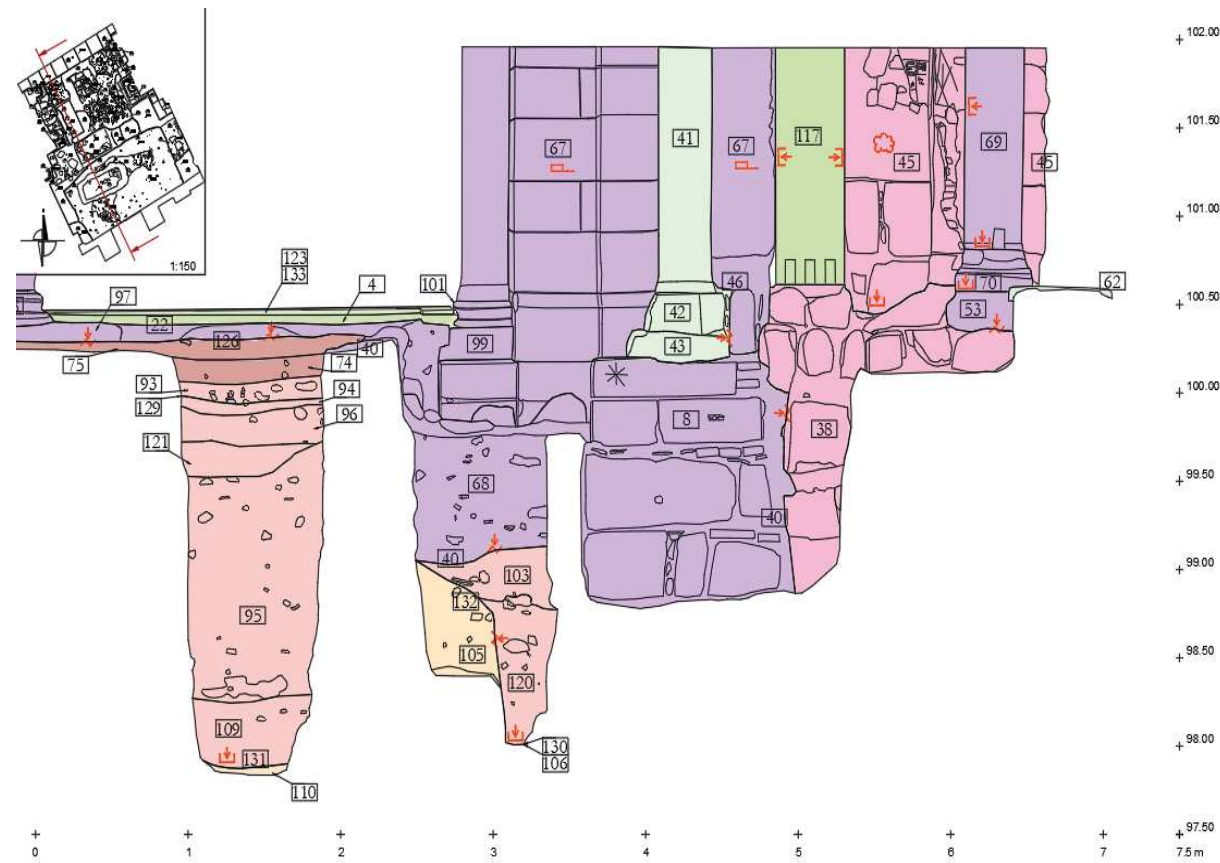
Plano de Periodización. Intervención de la Puerta a la nave 17.
